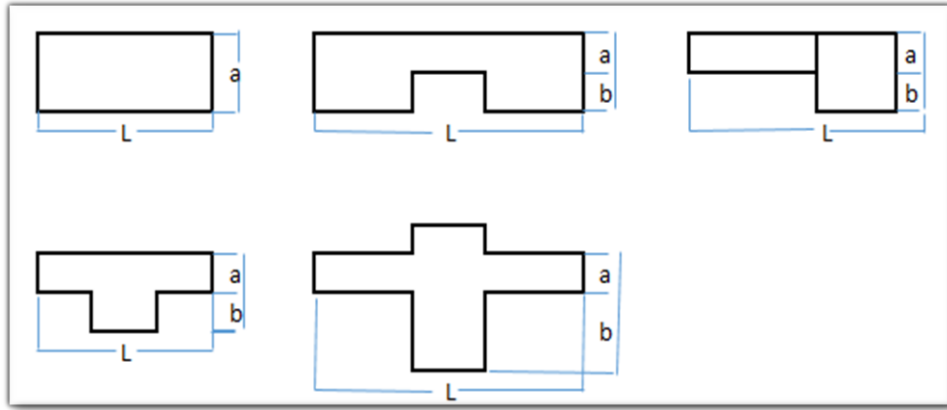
Configuración en planta de la estructura para el cálculo del parámetro N° 6
